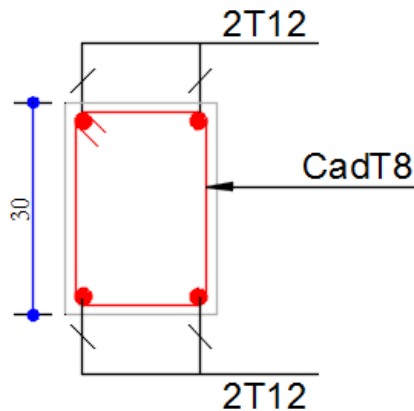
Schéma de ferrailage de la Poutre chaînage
